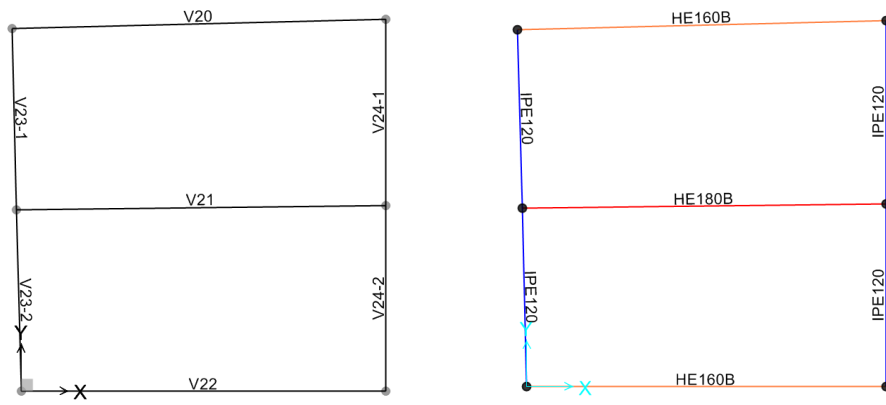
Numeração e secções das vigas metálicas do piso 2 (V20 a V24)
